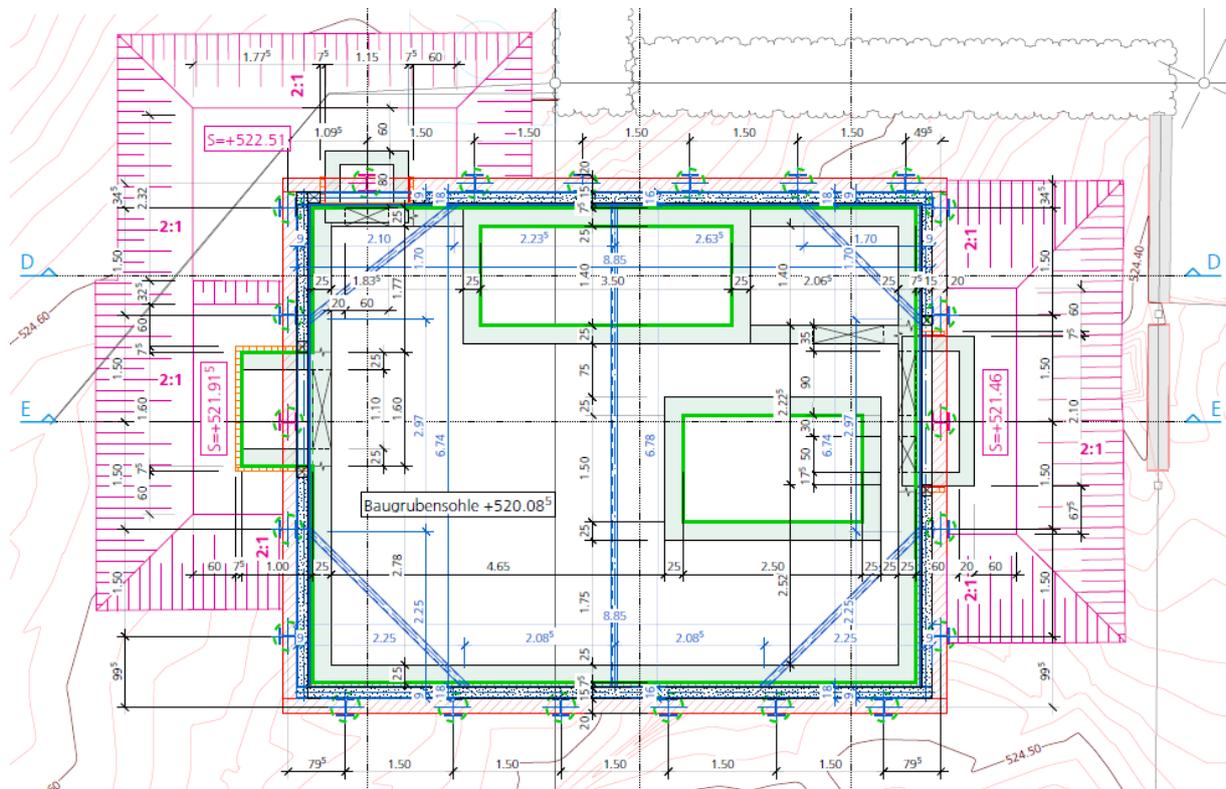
Grundriss Baugrube Mühlemattstrasse
